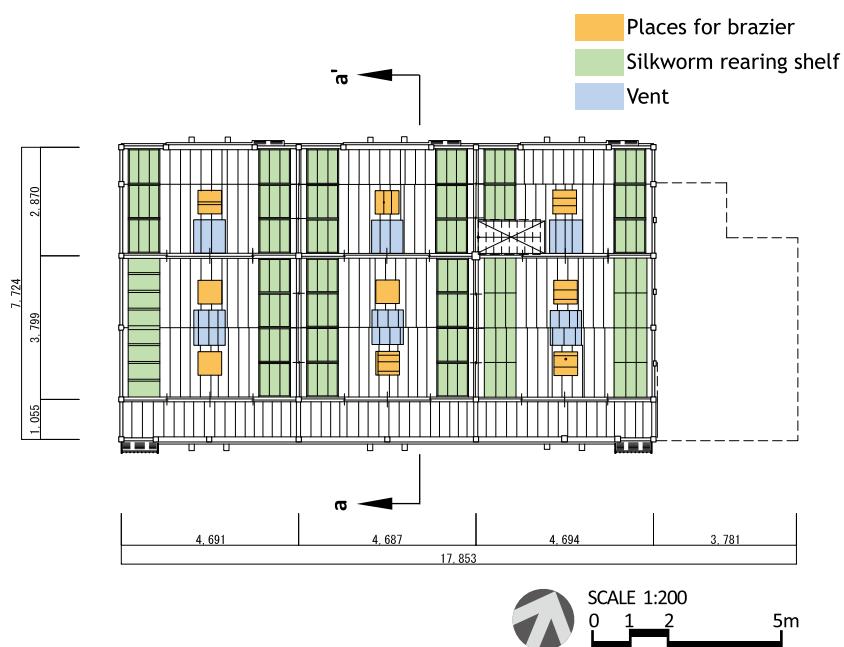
S3 高山社跡 主屋兼蚕室二階平面図
